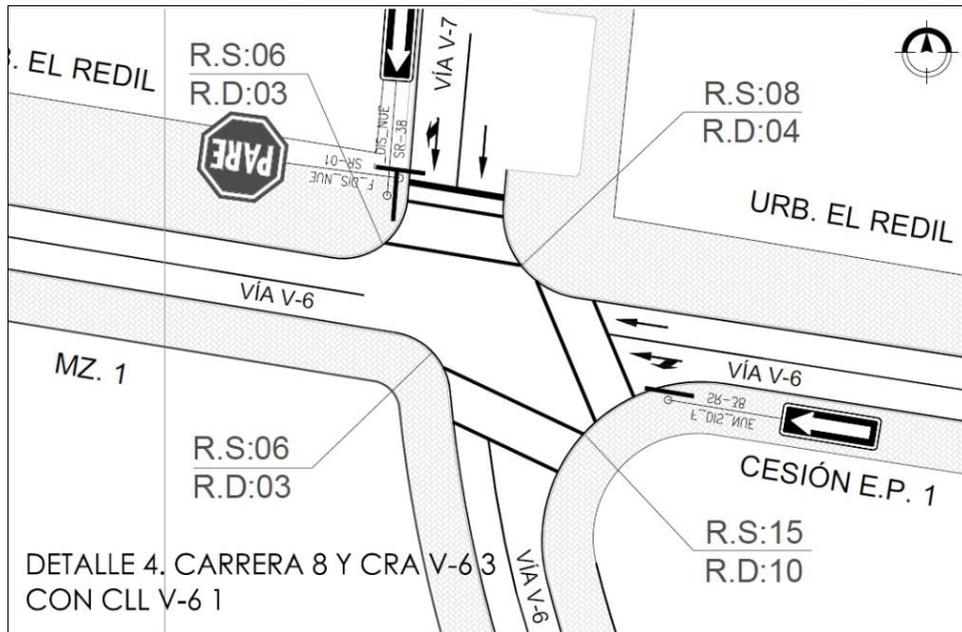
Detalle radio de giro carrera 7 con V-6 (1)
